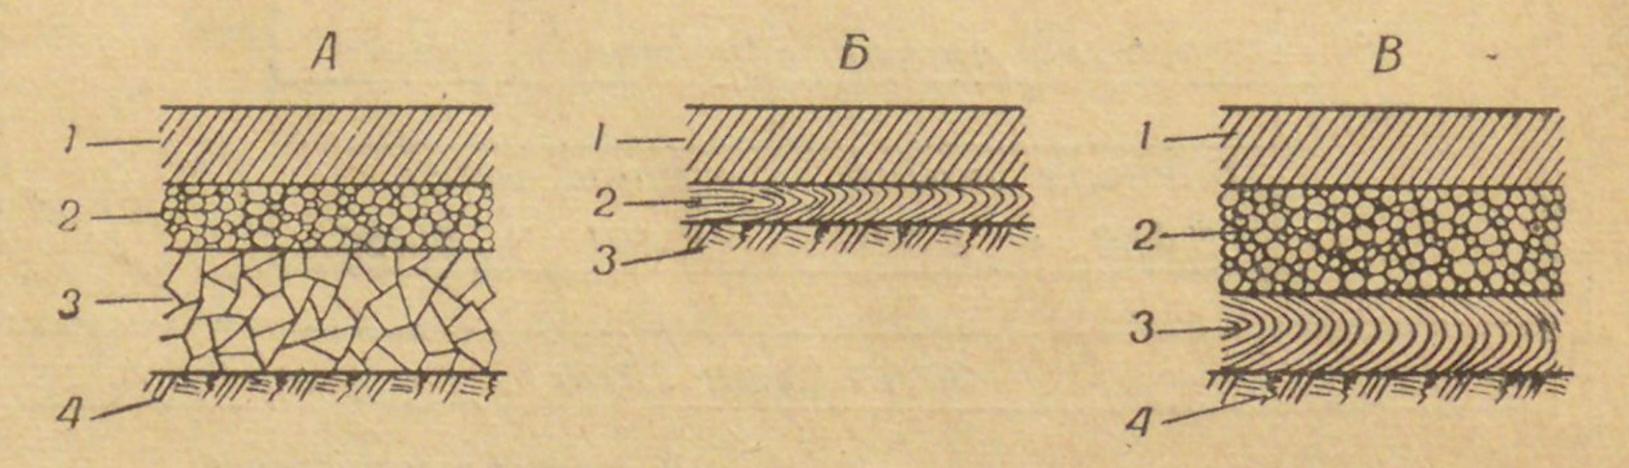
Конструктивный разрез полотна с нежестким покрытием из неводостойких грунтовых смесей
